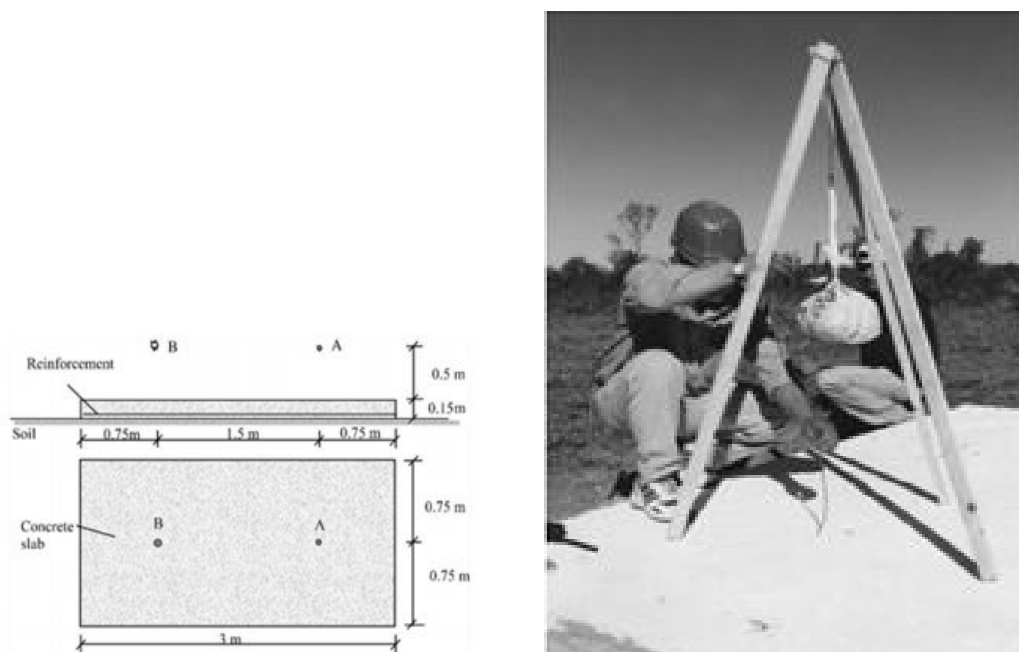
Geometria do pavimento e o explosivo utilizado [32]
